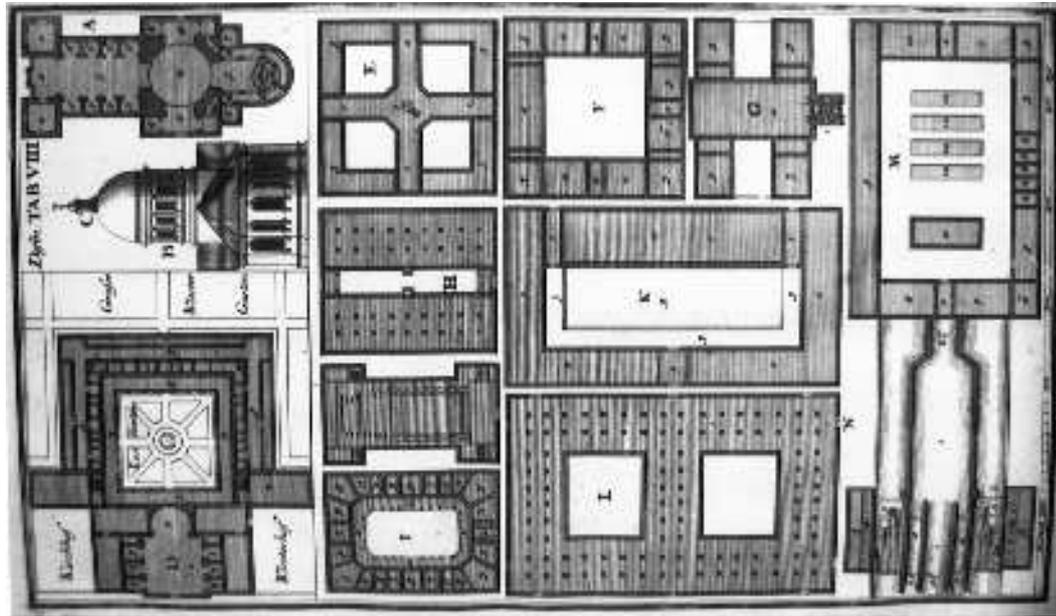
Sturm, Grundrißschemata von Gebäudetypen, 1718
